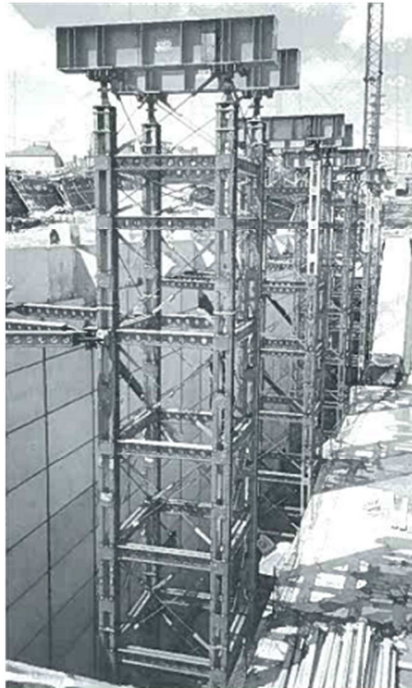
Torre Contraventada Contra um Muro Com Dispositivos de Ajuste de Altura ao Solo Contraventados por Tirantes [3]
